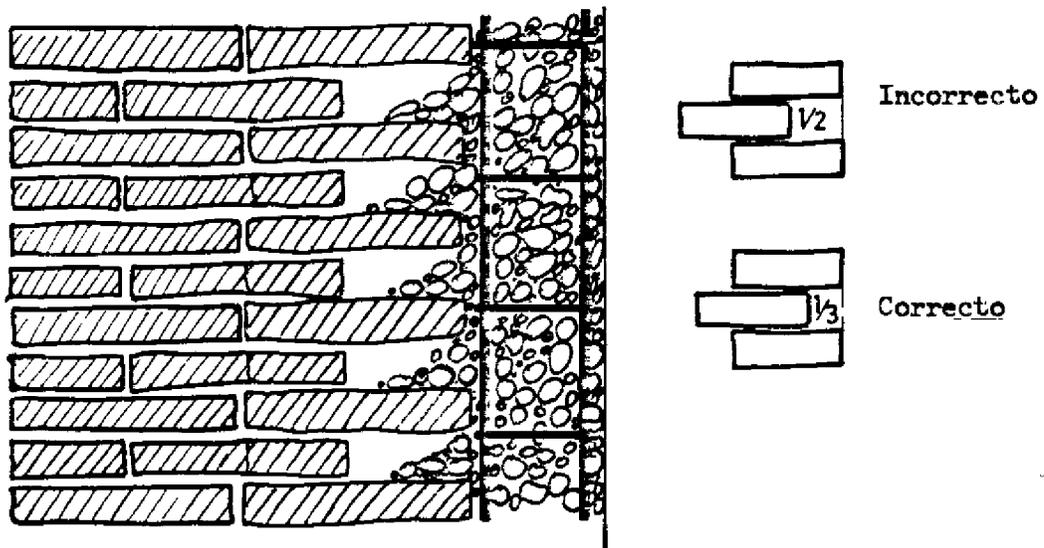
UNIONES DE ALBAÑILERIA Y PILAR
